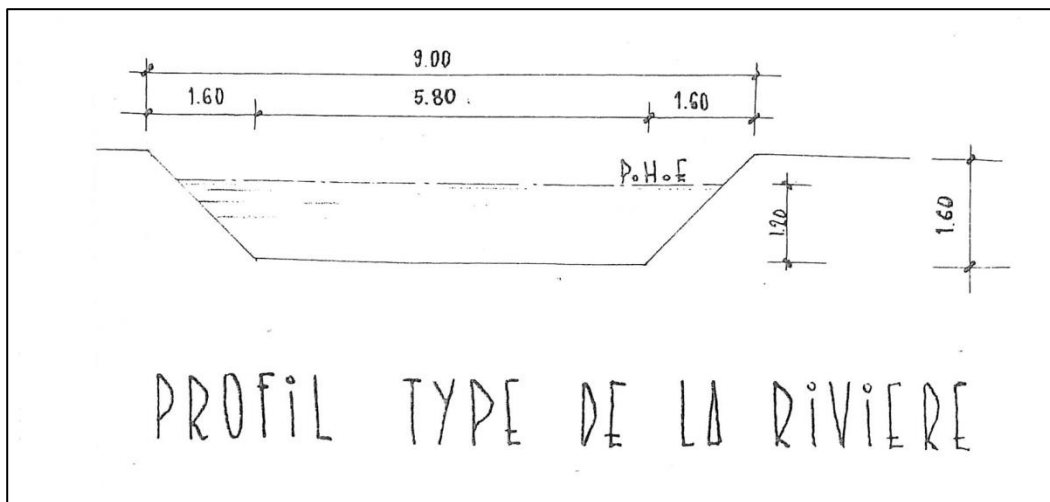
Profil en travers de la rivière avant les travaux de recalibrage (SIVLO)
